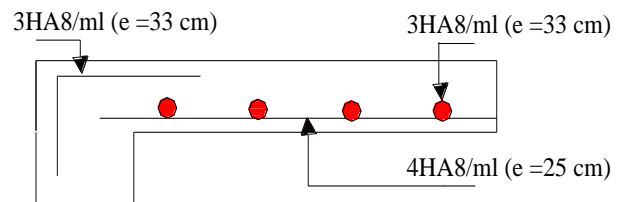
Vue en coupe A-A du ferrailage de la dalle au-dessous de l'ascenseur.
